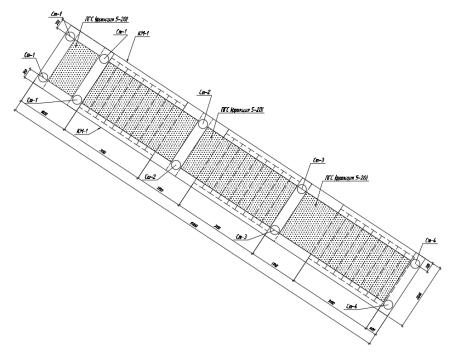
Схема расположения стальных свай и монолитных косоуров
